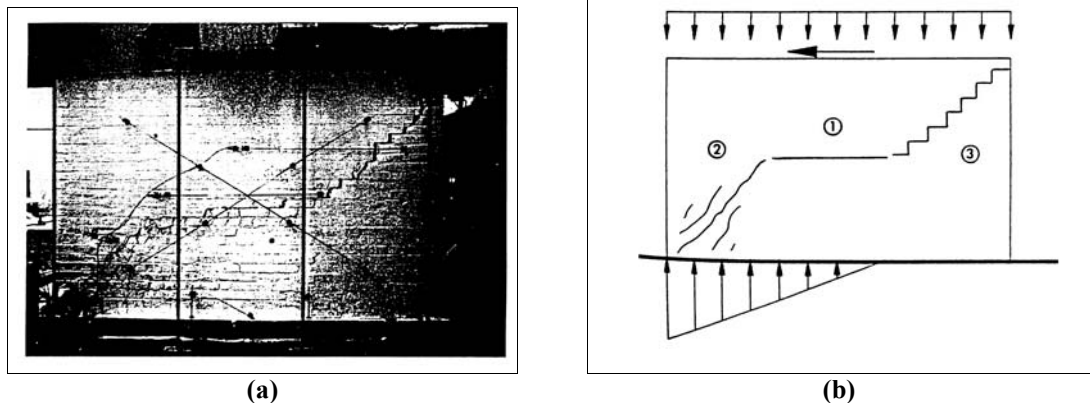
Distribuição final de fissuras em um dos painéis: (a) Paineis após realização do ensaio; (b) Distribuição e seqüência da fissuração [Epperson (1992)].
